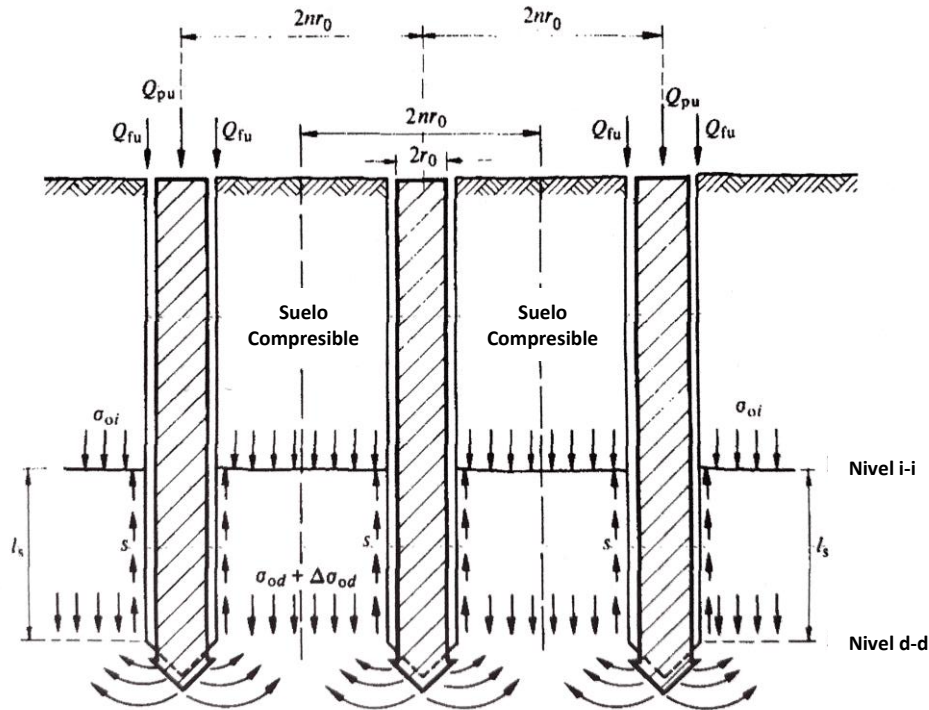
Grupo de pilotes (Zeevaert, 1983)
